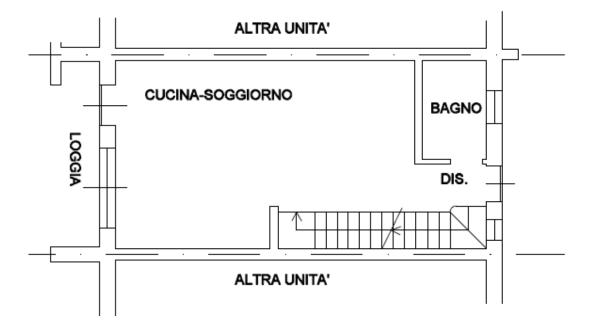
schema a vista (fuori scala) della porzione di schiera mapp. 2530 sub 32 ALLO STATO GREZZO
